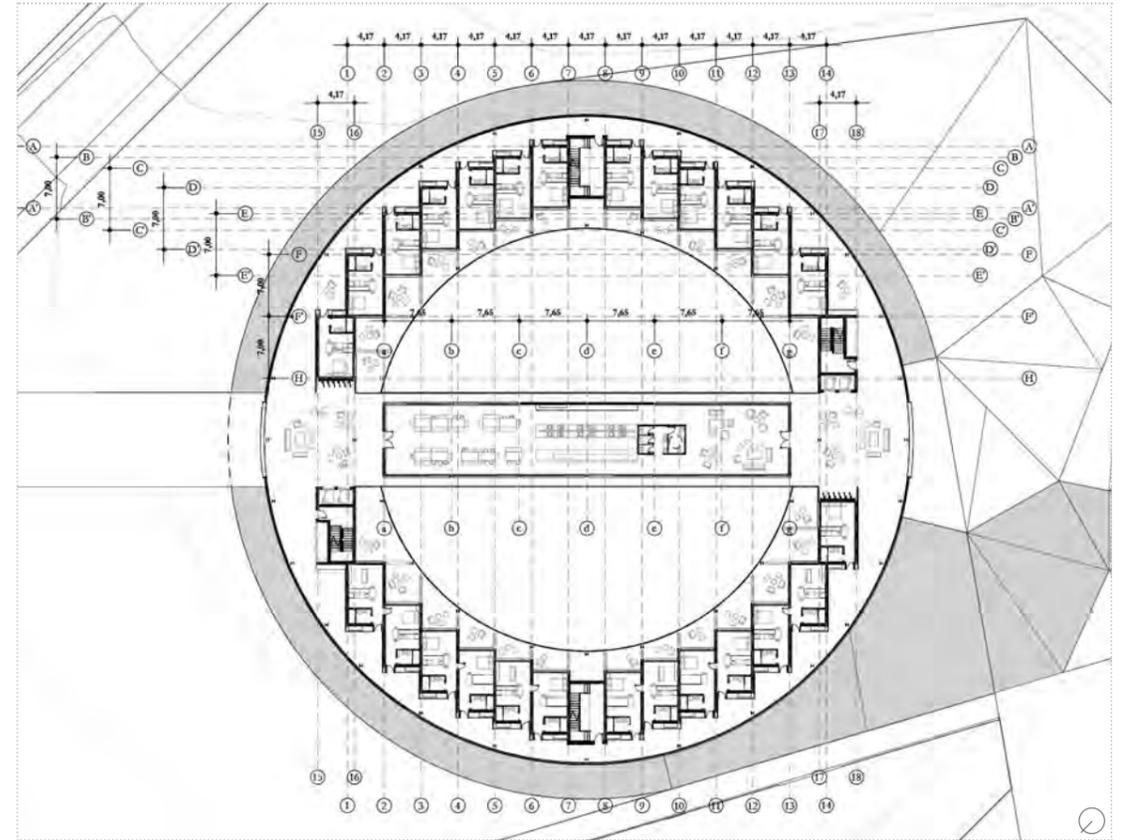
| Planta dos eixos estruturais (Silo A), Escala 1:800
